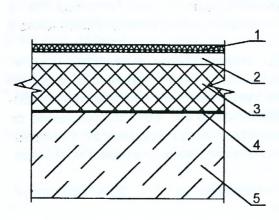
Конструкция совмещенного покрытия жилых и общественных зданий:
